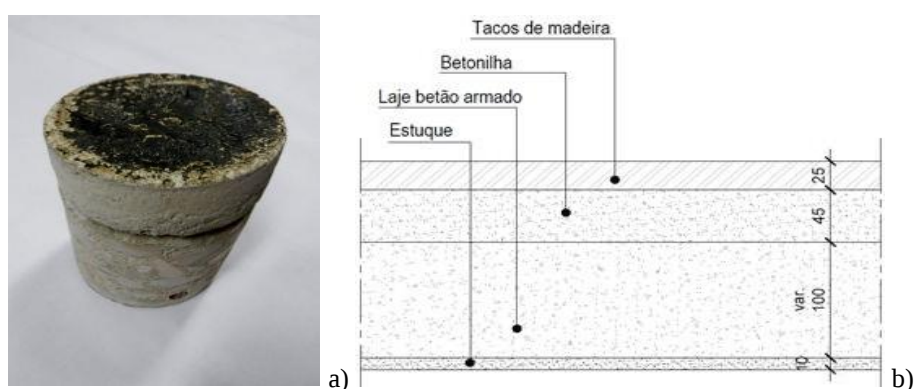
Constituição do pavimento do piso tipo: a) sondagem efetuada; b) pormenor tipo
